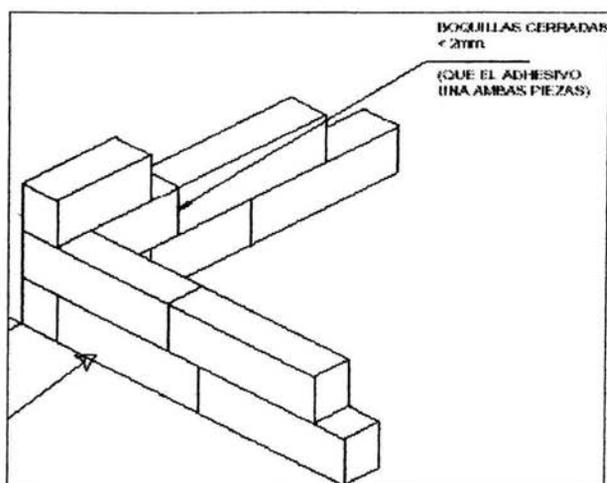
En la figura se muestra el traslape óptimo de los muros de bloque, para garantizar comportamiento estructural en zonas no sísmicas.
